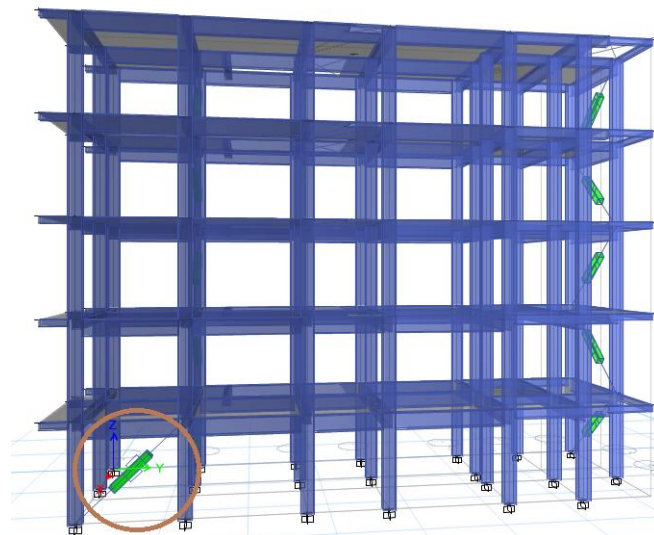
Disposición de disipadores vista en planta-segunda estructura.
